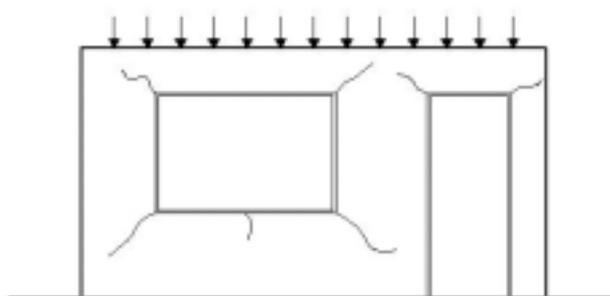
FIGURA: Fissuração típica em parede com presença de aberturas, devido à atuação de carga uniformemente distribuída.
